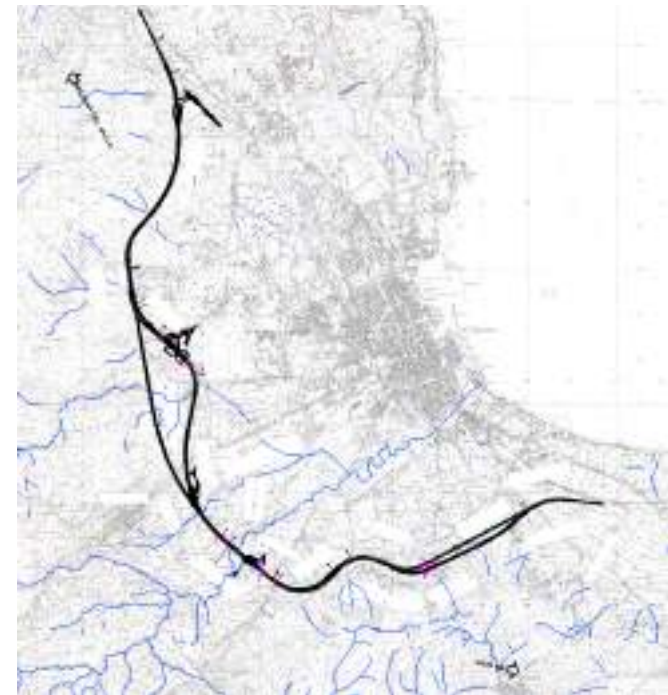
Stralcio planimetrico delle interferenze idrauliche
